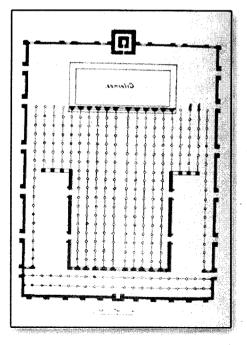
جامع تنمل بالمغرب الأقصى (مسقط أفقي) عن : تيراس
